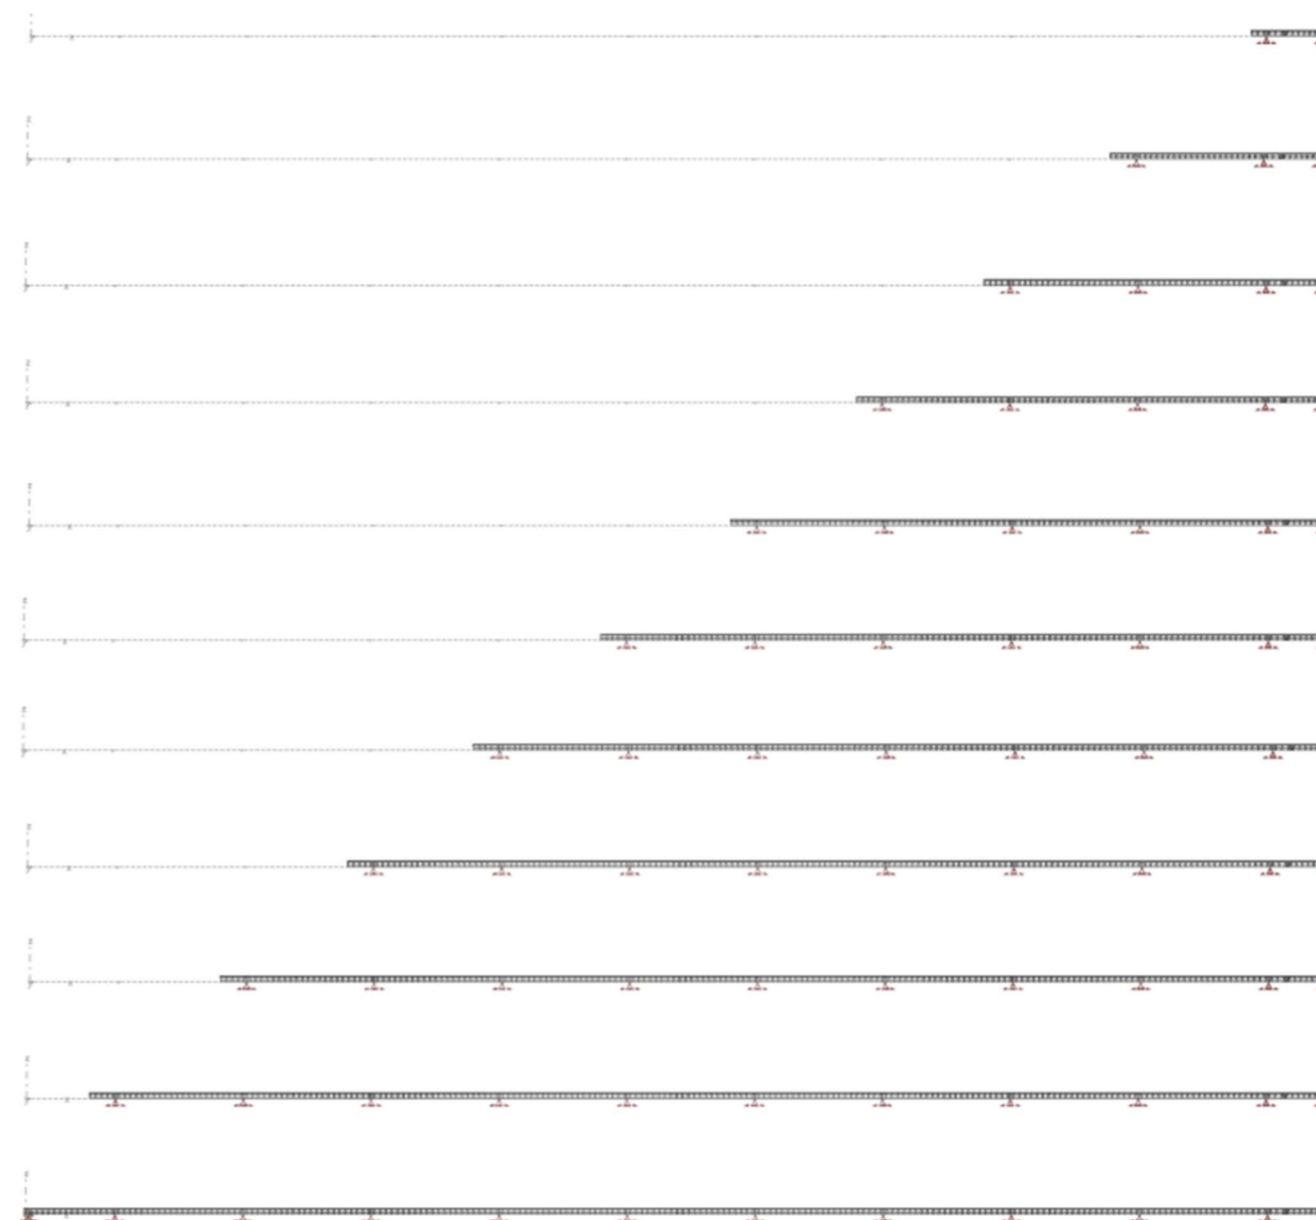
Fases 1 a 11 introducidas en el modelo de cálculo en el proyecto constructivo (Fuente: Documentación aportada)
